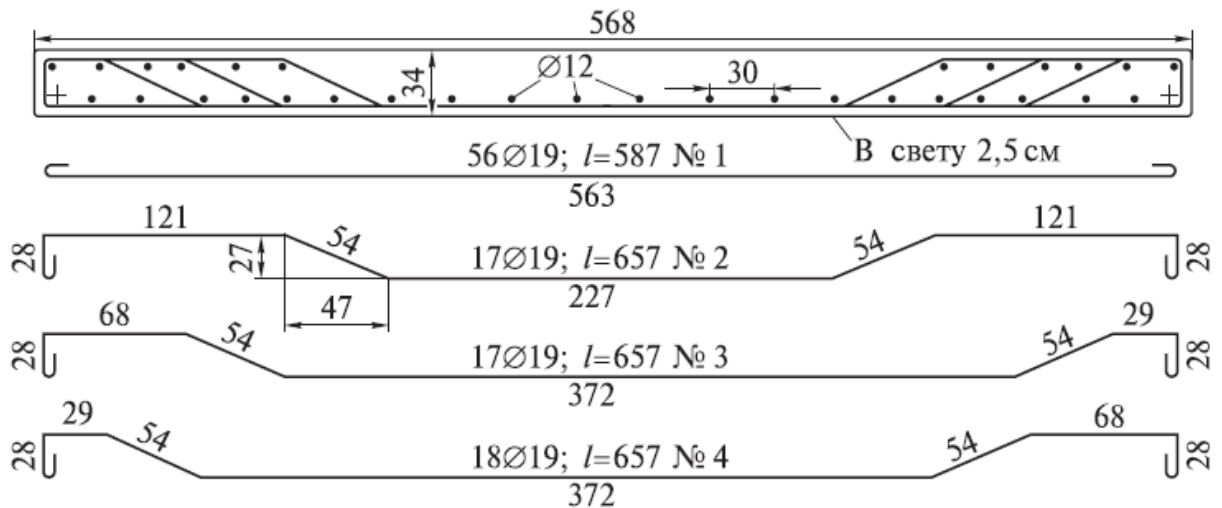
Схема продольного армирования монолитного пролетного строения длиной 6 м
